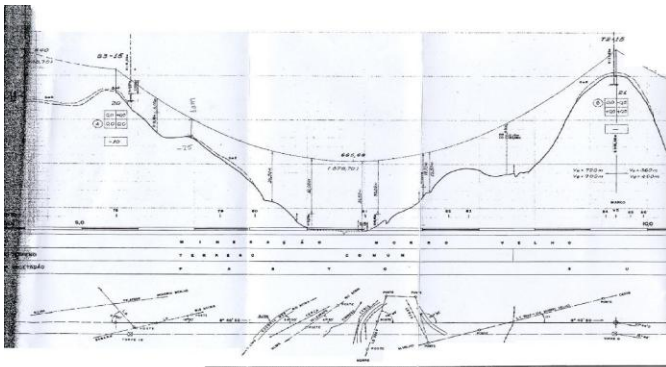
Perfil e Planta da Linha de 138 kV em estudo.
